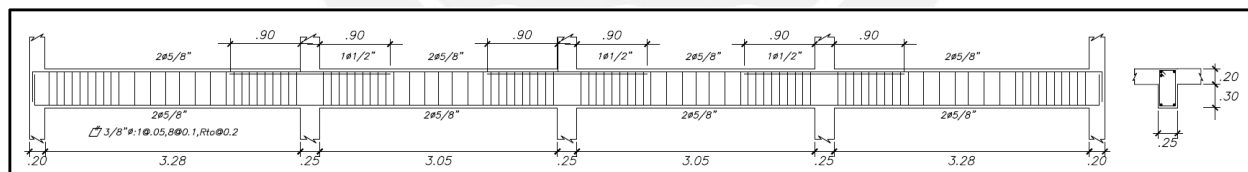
Diseño de viga eje 6. Longitudes en metros.
